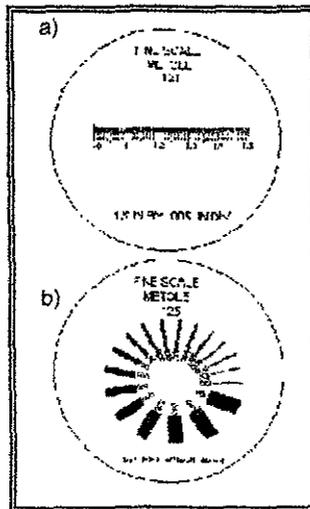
Plantillas circulares usadas comúnmente en la medición de grietas
